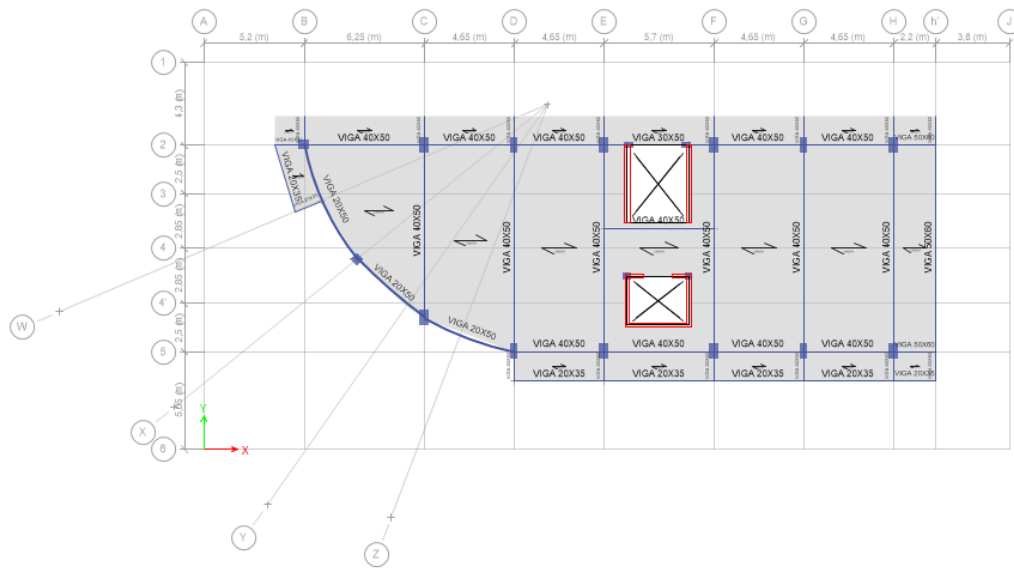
Planta tipo nivel +10.08 m a 27.36 m Edificio Silva Núñez
